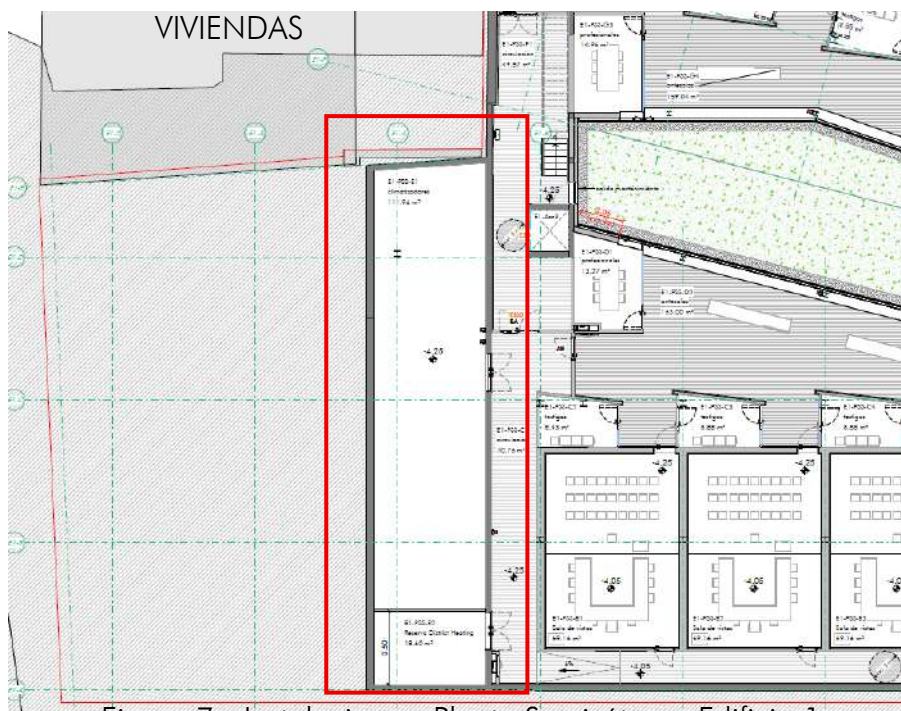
Instalaciones. Planta Semisótano. Edificio 1
